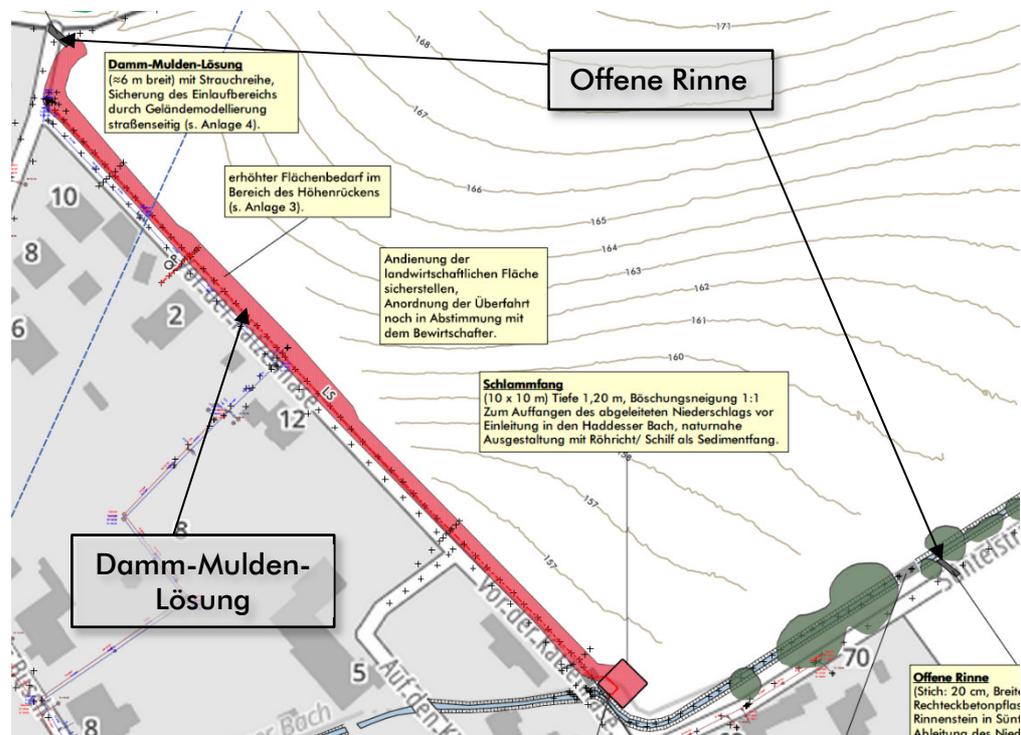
Lageplan Planung (Ausschnitt aus Anlage 2)
